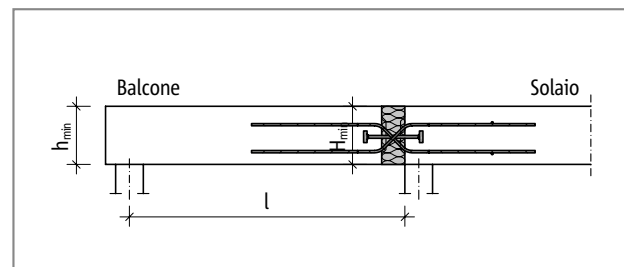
Schöck Isokorb® tipo QP80L-VV: schema statico
